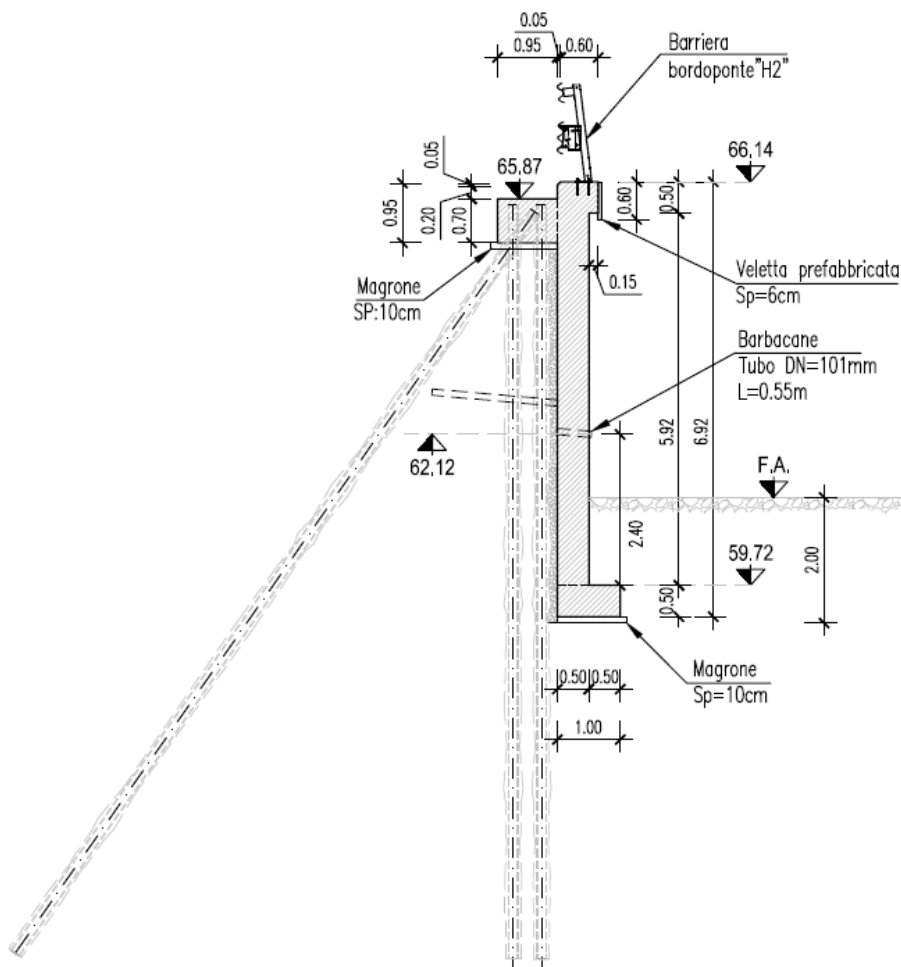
Ponte 1, Muro d'argine, schema carpenteria
